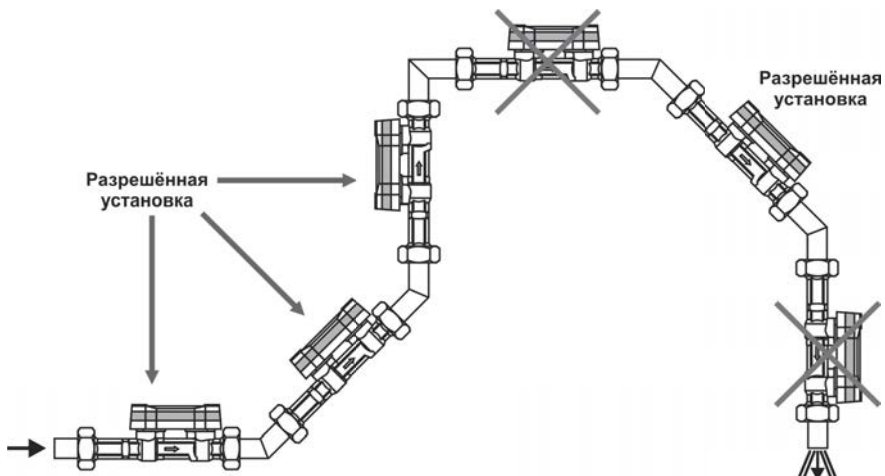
Монтаж расходомеров в трубопровод
